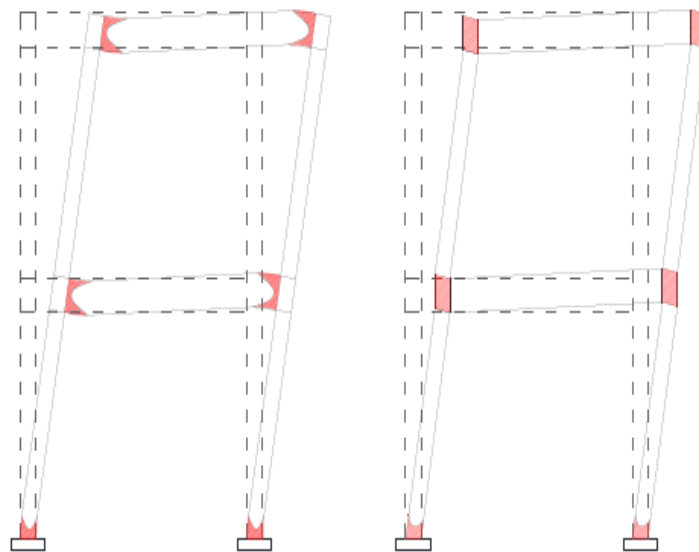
Zona de deformaciones inelásticas en estructuras aporticadas de acero estructural
